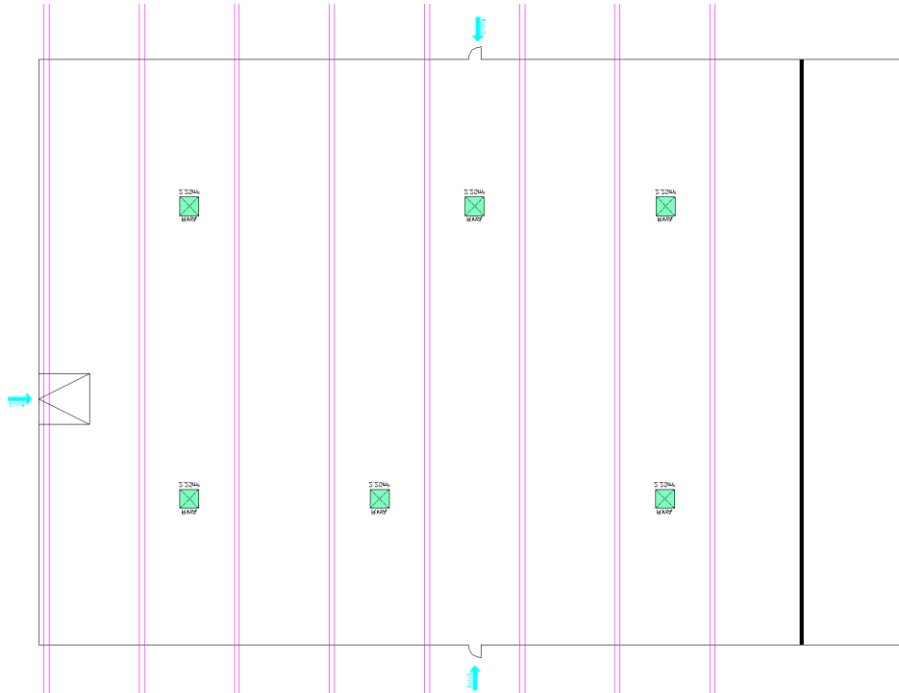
Schematischer Grundriss der Halle mit Einbindung der RWA und Zuluftflächen (eigene Darstellung)
